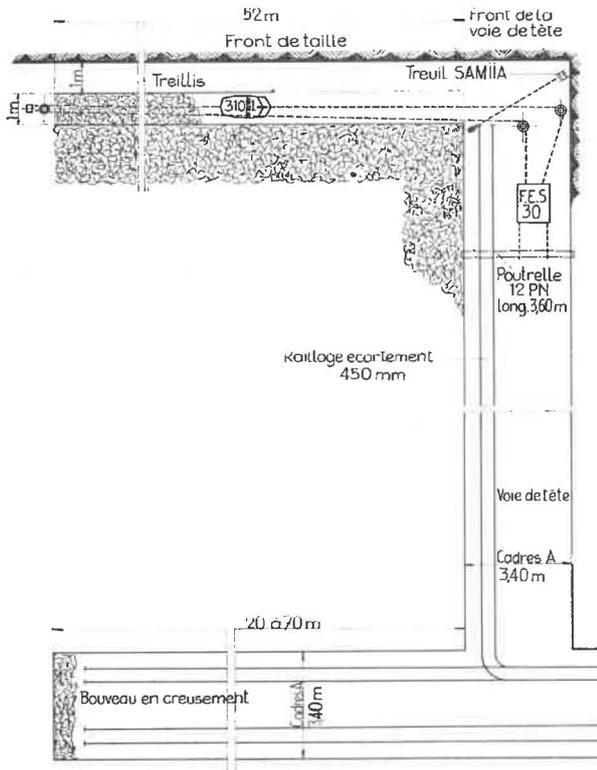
Remblayage en taille par scraper (les terres proviennent du bosseyement de la voie de tête). Disposition générale du chantier. Havée de 50 m en cours de remblayage.
